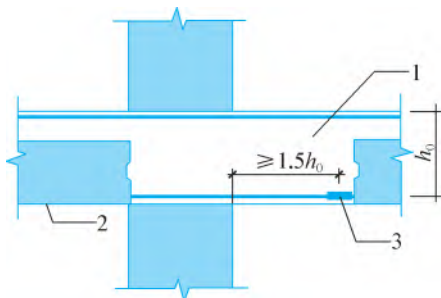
梁纵向钢筋在节点区域外的后浇段内连接示意
